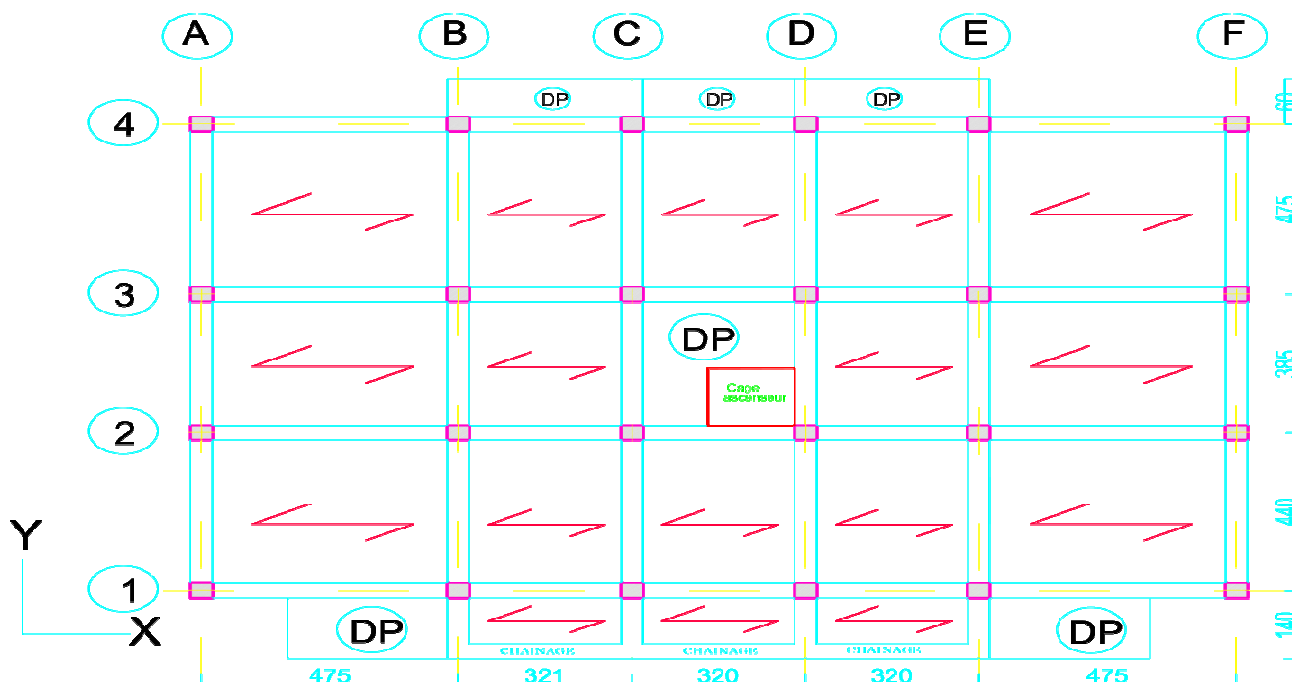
schéma montrant la disposition des poutrelles dans la terrasse inaccessible.
